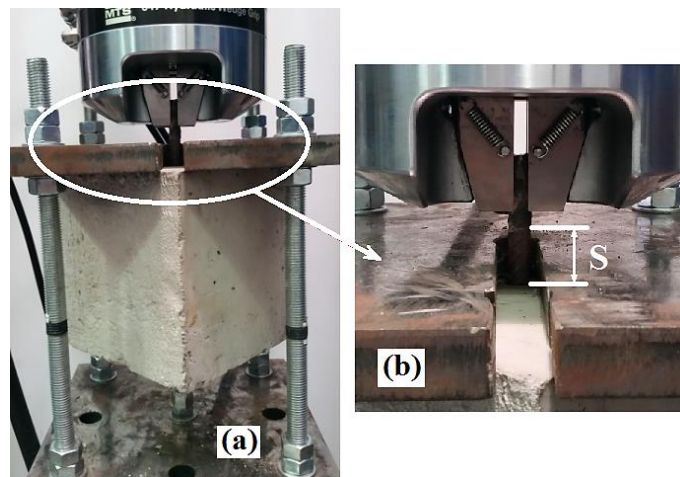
Ensaios da Etapa III: (a) Ensaio dos corpos de prova prismáticos, (b) Deslizamento da barra durante o ensaio.
